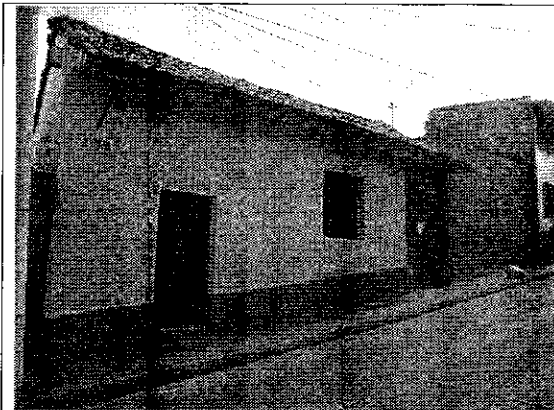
Detalle de la fachada del predio donde se presentan los daños en el muro de cerramiento.
